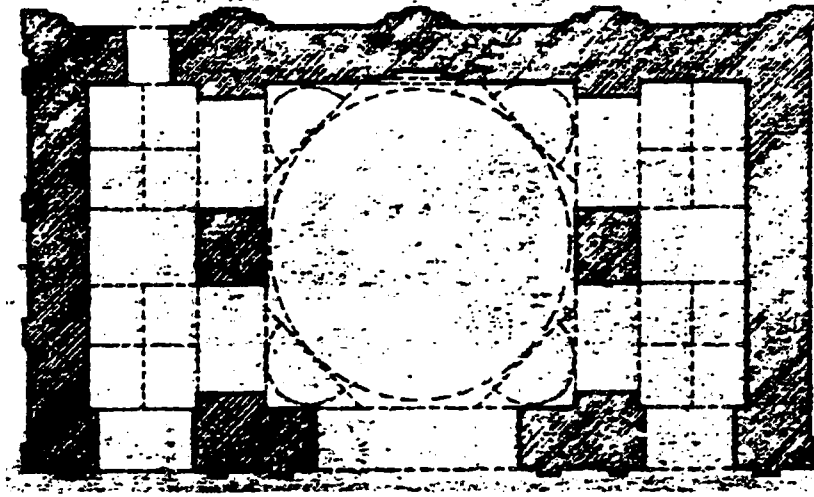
Samarra. Ebu Dulef Camii. Plan (Creswell'den)
